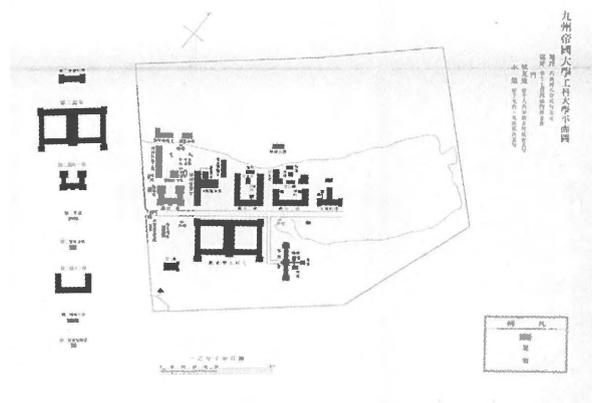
：『九州帝国大学一覧 従大正三年 至大正四年』（1914年度）平面図
